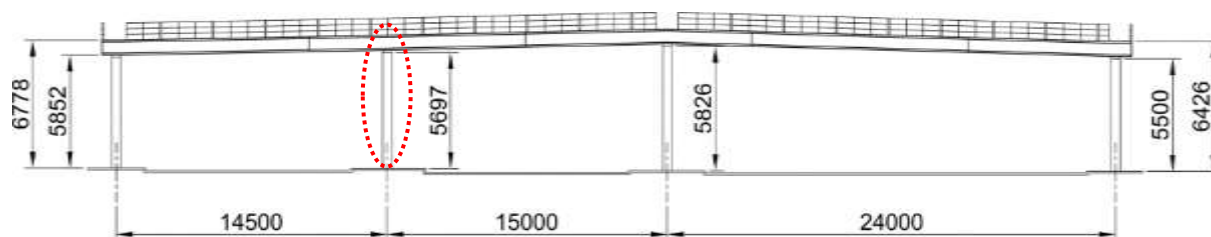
Projeto da Passarela – Vista longitudinal: trecho analisado onde, assinalado em vermelho, é mostrado o pilar ausente, que dividiria o vão reforçado em dois.
